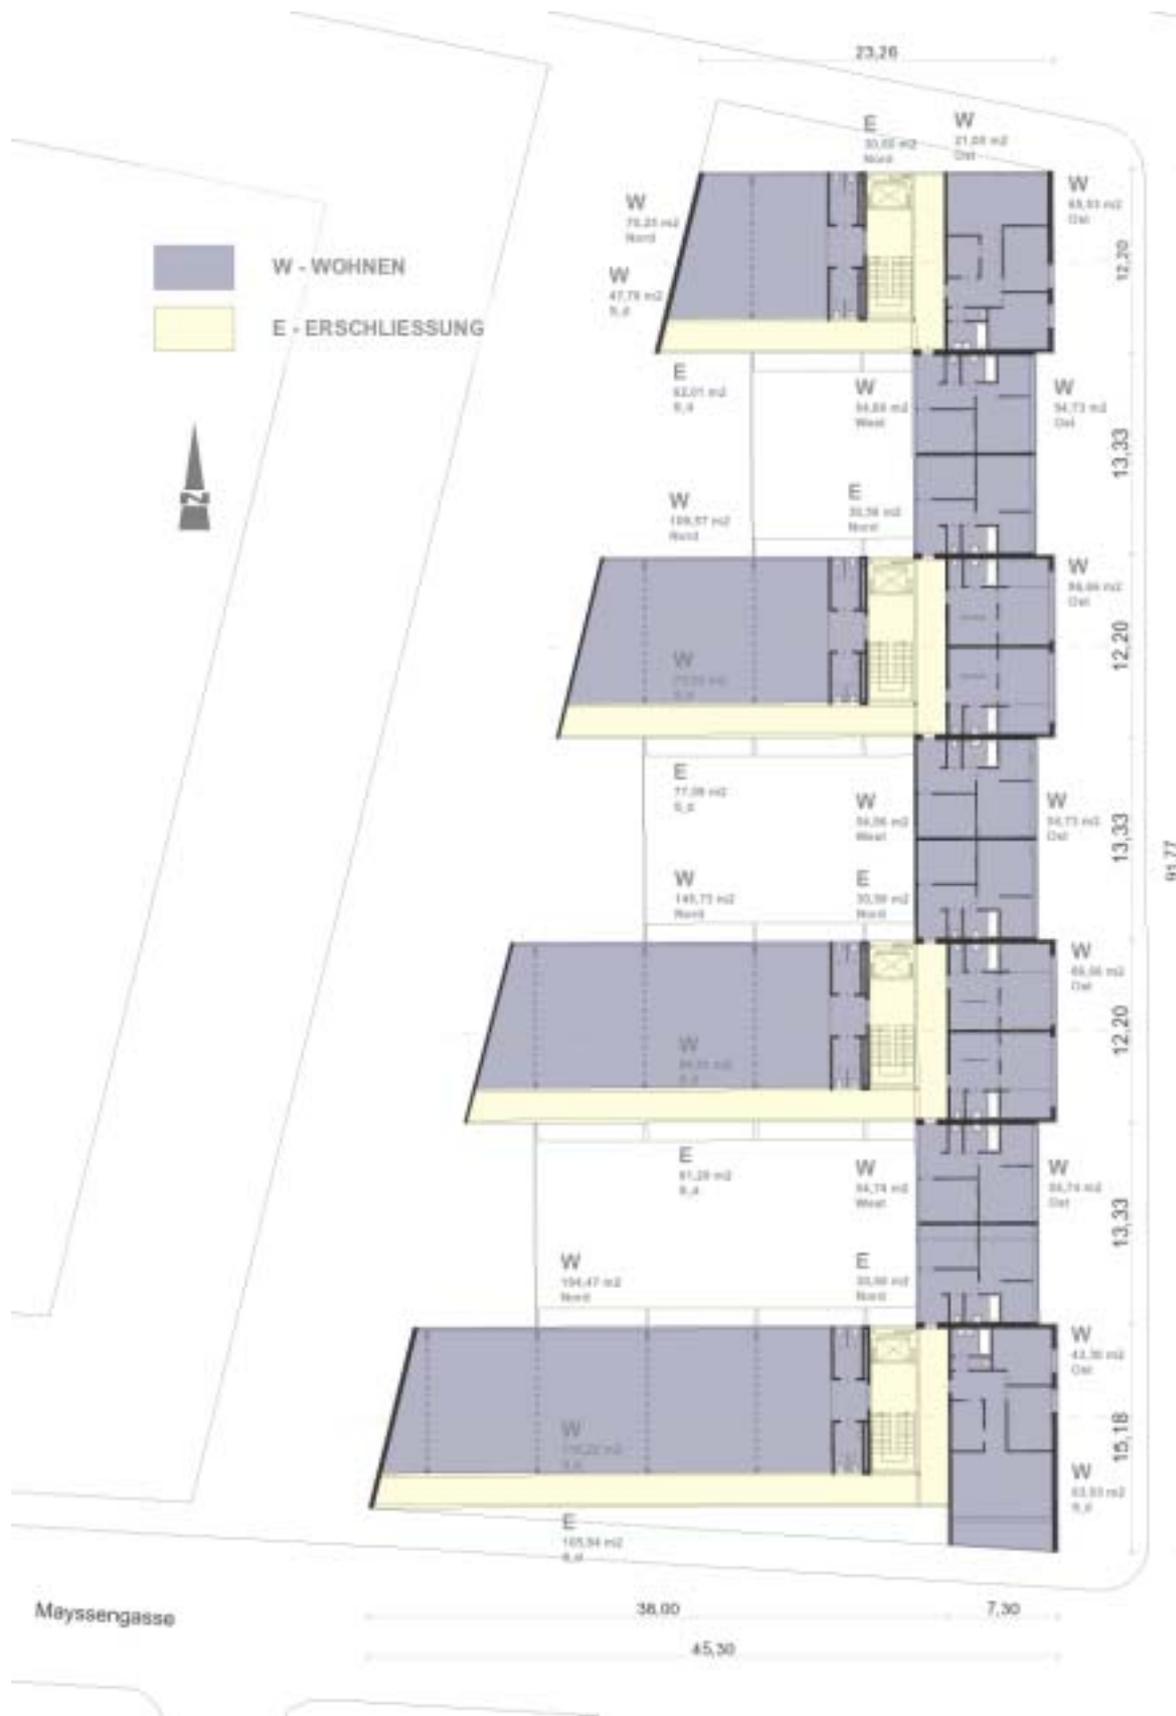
Mayssengasse, Grundriss DG, M = 1:500
